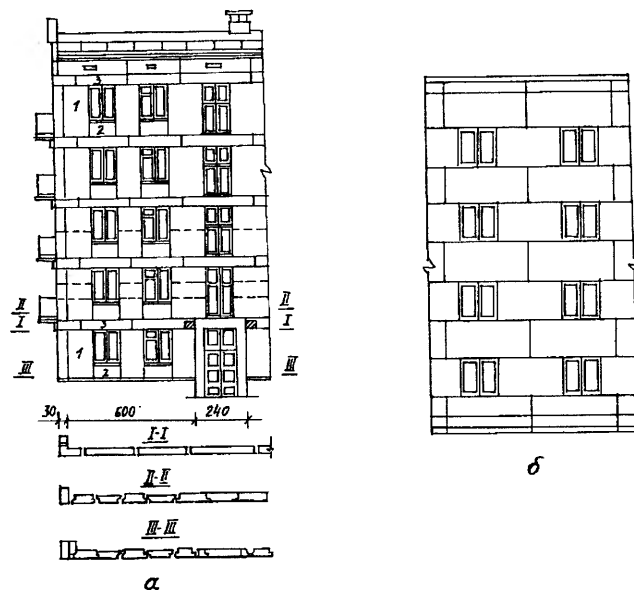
Фрагмент фасадной стены: а – из бетонных блоков при двухрядной разрезке; б – из кирпичных блоков при двухблочной (ленточной) разрезке; 1 – простеночный блок; 2 – подоконный блок; 3 – перемычный блок
